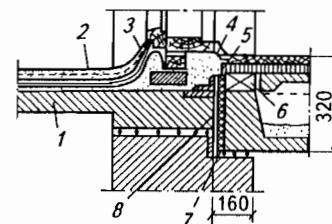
Сопряжение балконной плиты с наружной стеной
